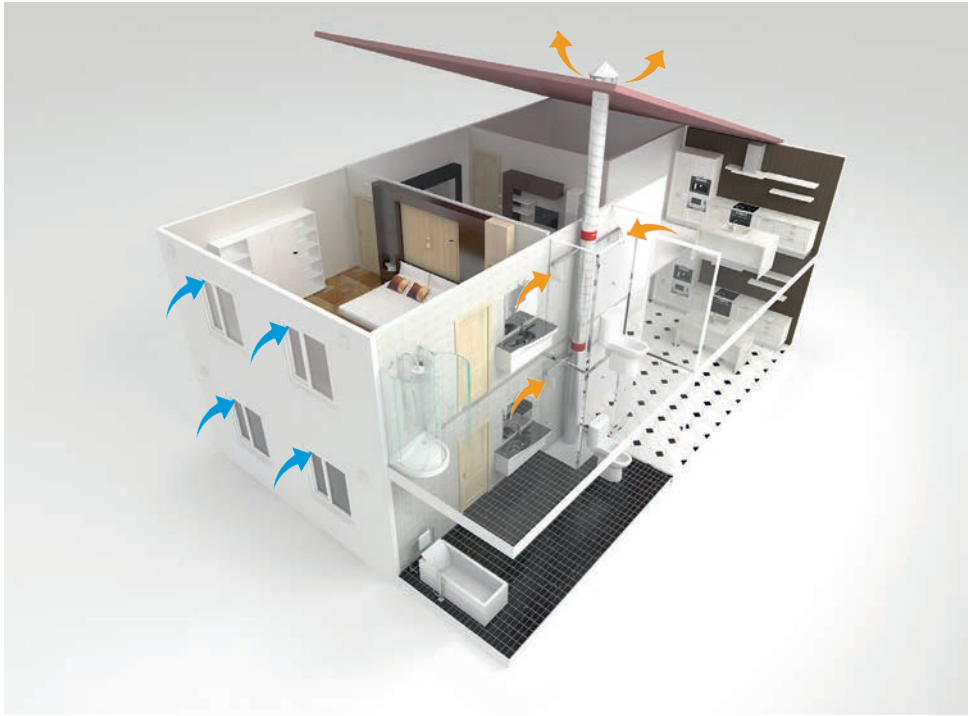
Витяжна вентиляція з побутовими каналними вентиляторами
